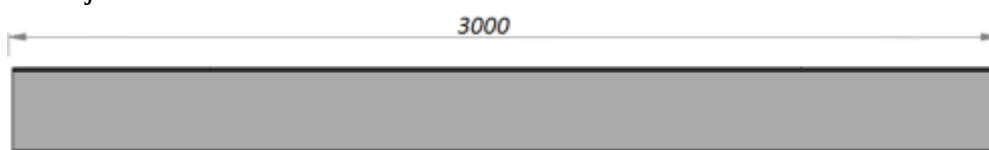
Viga de referência sem emenda (VREF1, VREF2)
